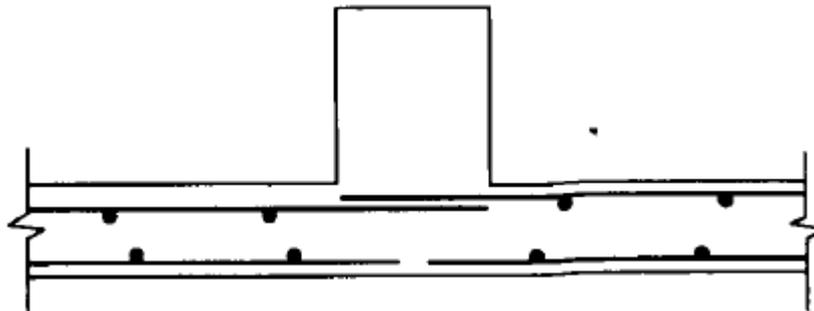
钢筋焊接网在反梁的布置
